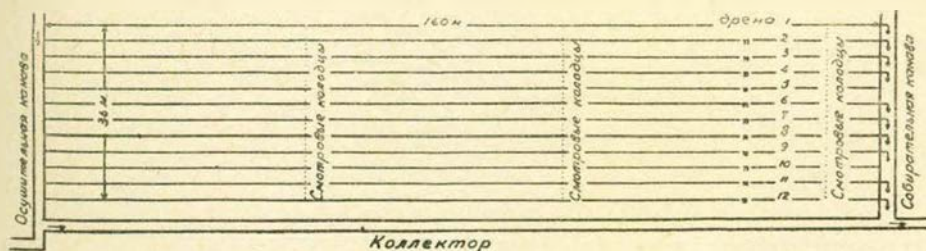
Схема опытной площадки по осушению кротовыми дренажами.
